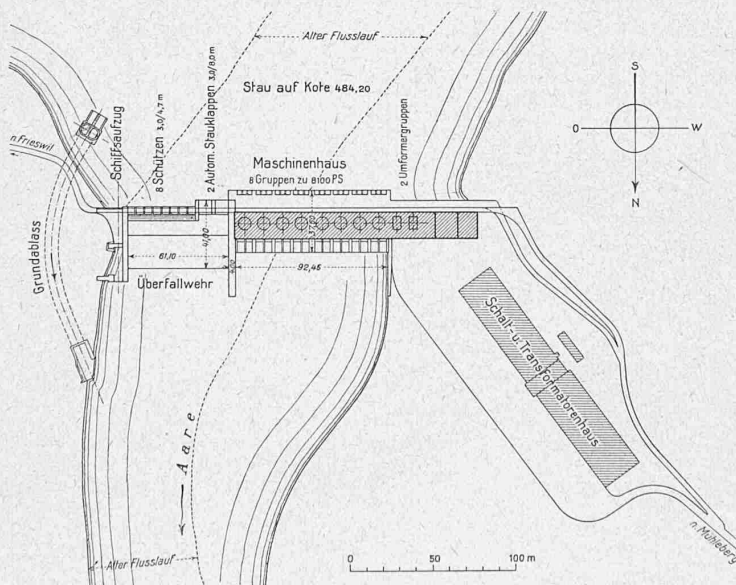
Lageplan des Kraftwerks Mühleberg. — Masstab 1:4000.
